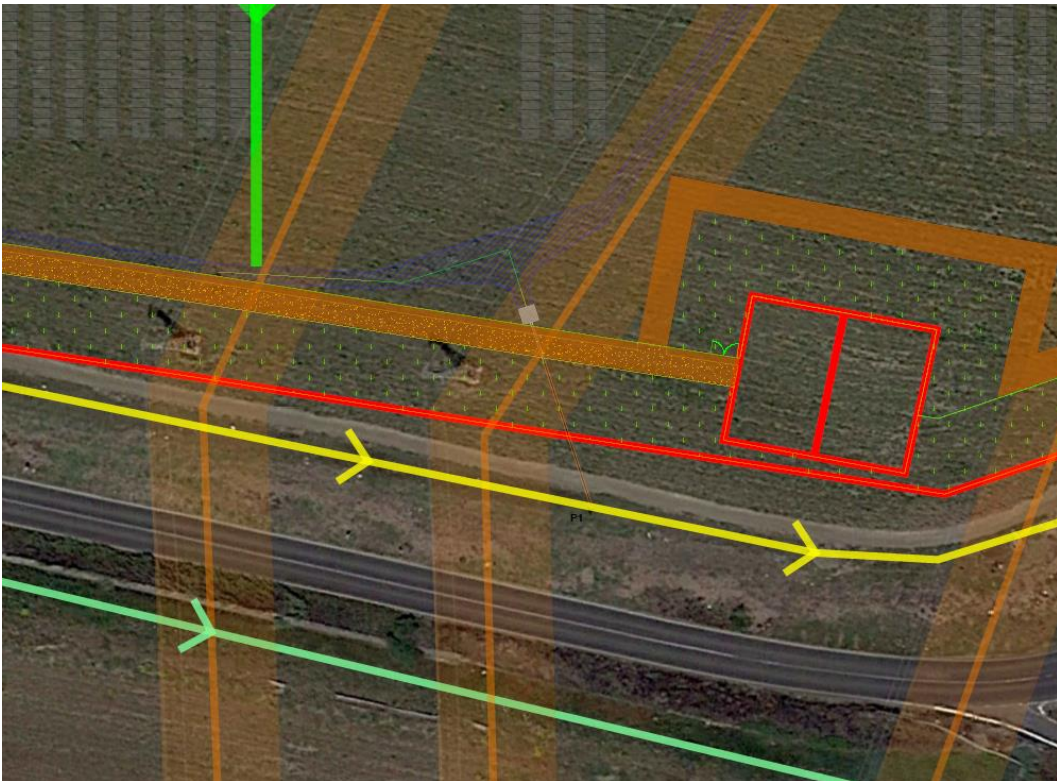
Particolare A – Scarico al CIR – Stralcio tavola progettuale
